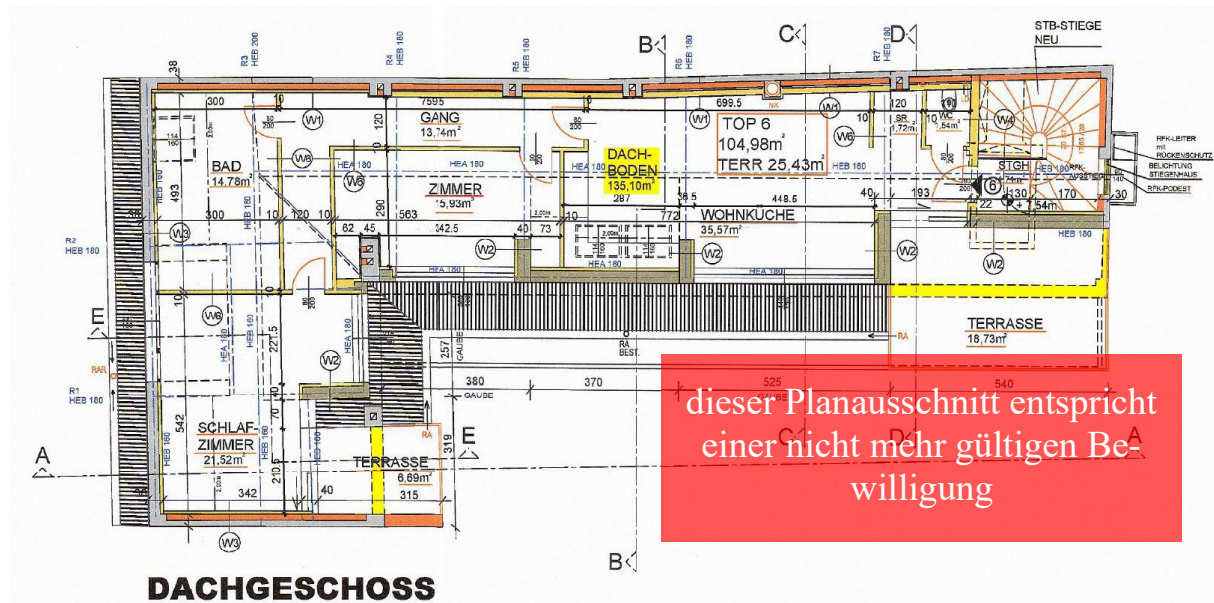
; Grundriss Top 6 aus dem Einreichplan Baubewilligung 06.06.2016. Geringfügig abgeändert.
